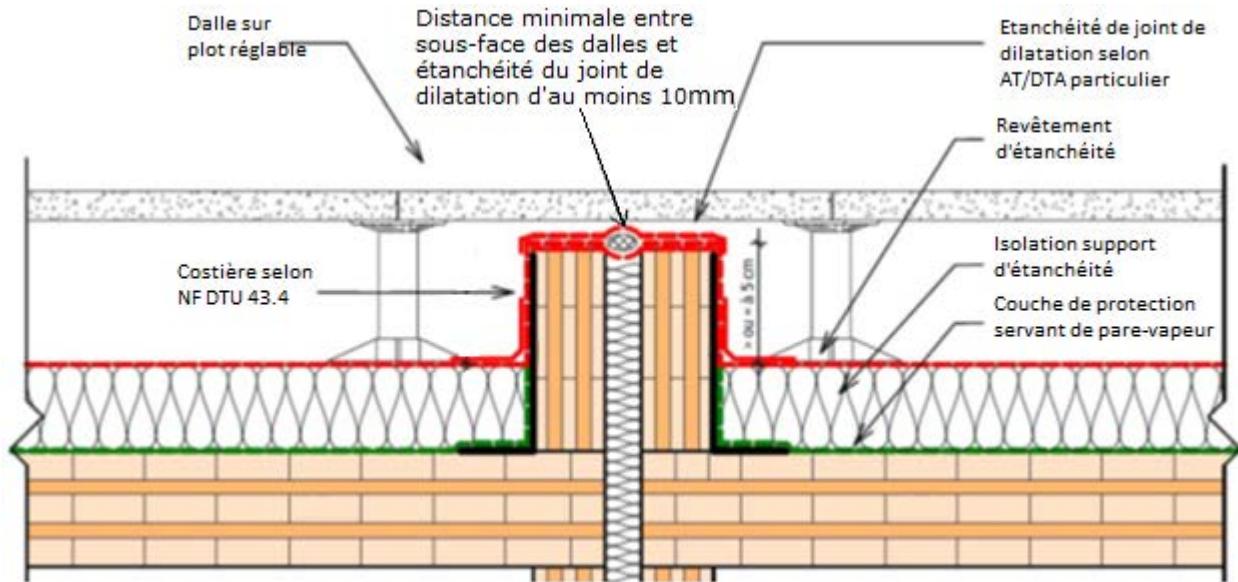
Principe de joint de dilatation en toitures accessibles piétons et séjour – Protection par dalles sur plots
